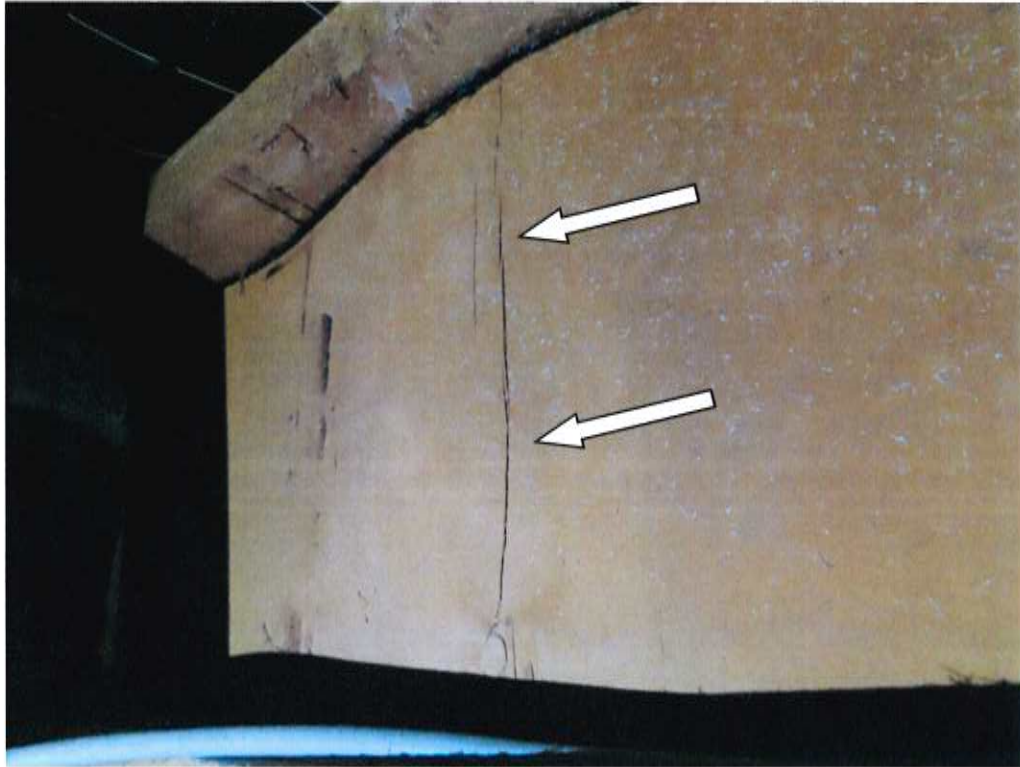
Holz-Wellstegträger: Vertikalrisse durch Wellsteg im Auflagerbereich (exemplarisch)
